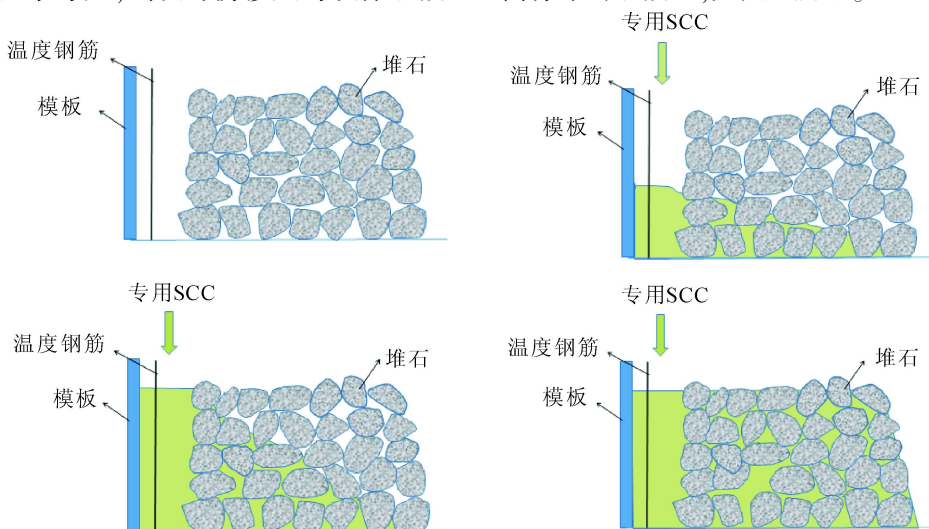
自密实混凝土防渗层与堆石混凝土坝体一体化浇筑示意图
